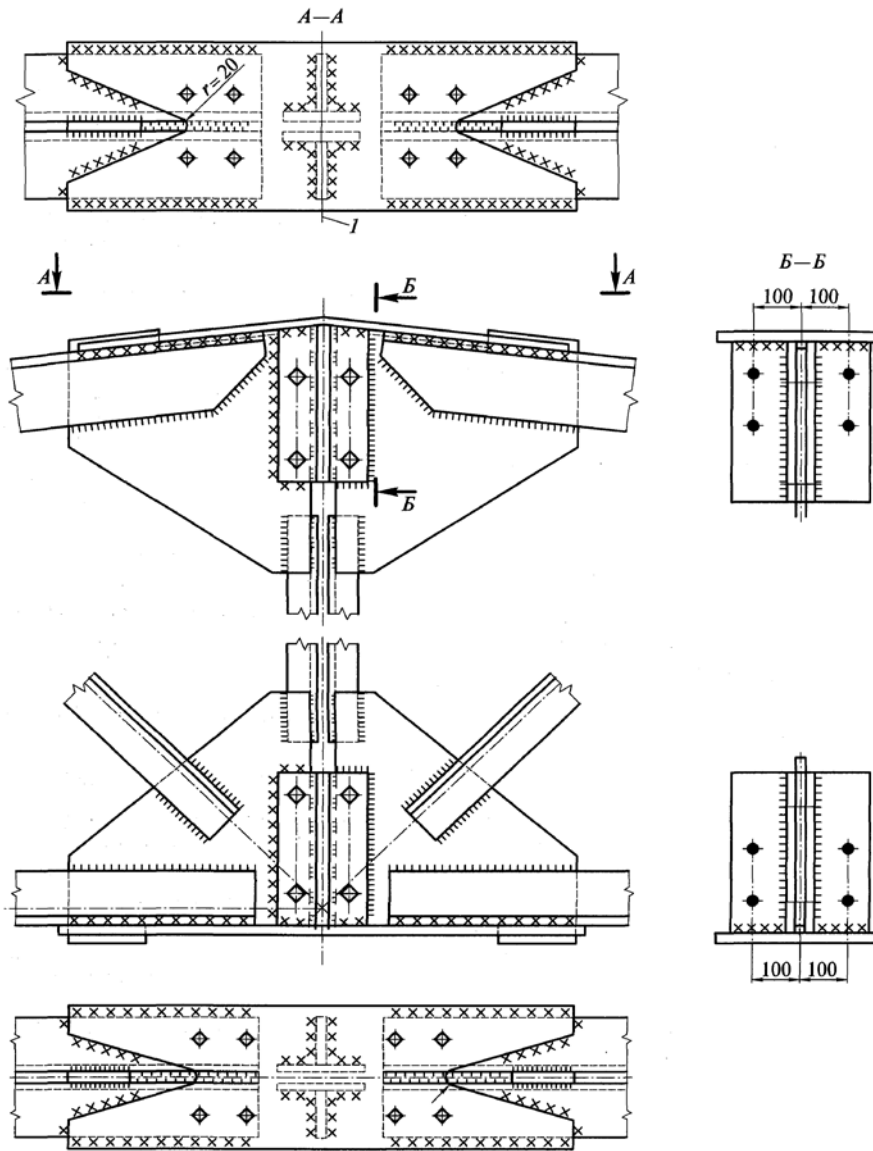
Монтажный узел фермы з різною фасонкою:
